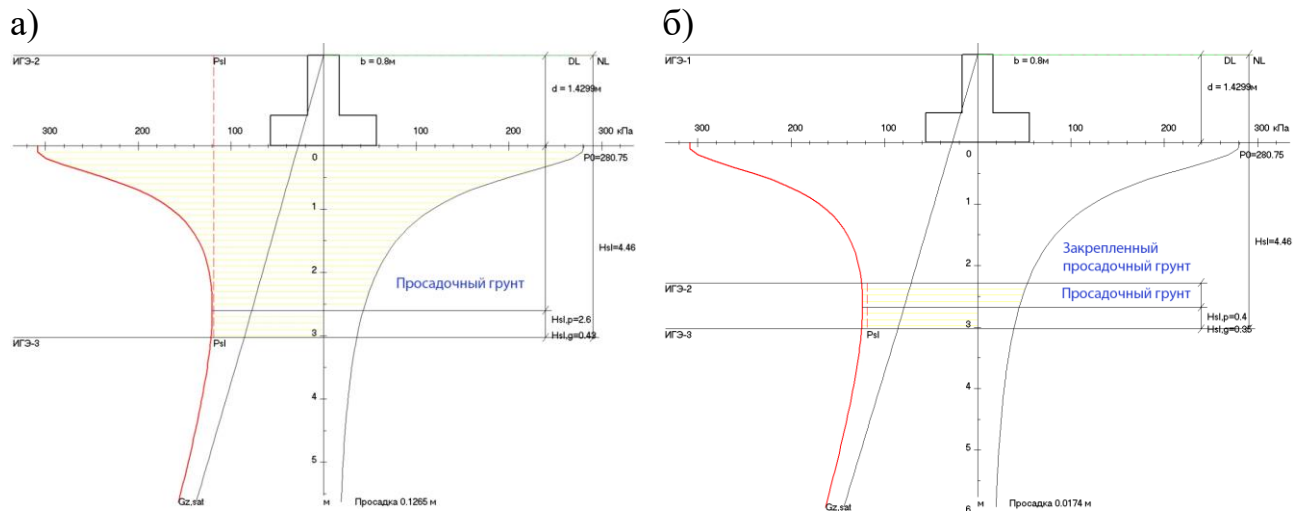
Расчетная схема для определения просадки под элементом фундамента: а – без закрепления основания; б – с частичным закреплением на 75% от просадочной толщи.
